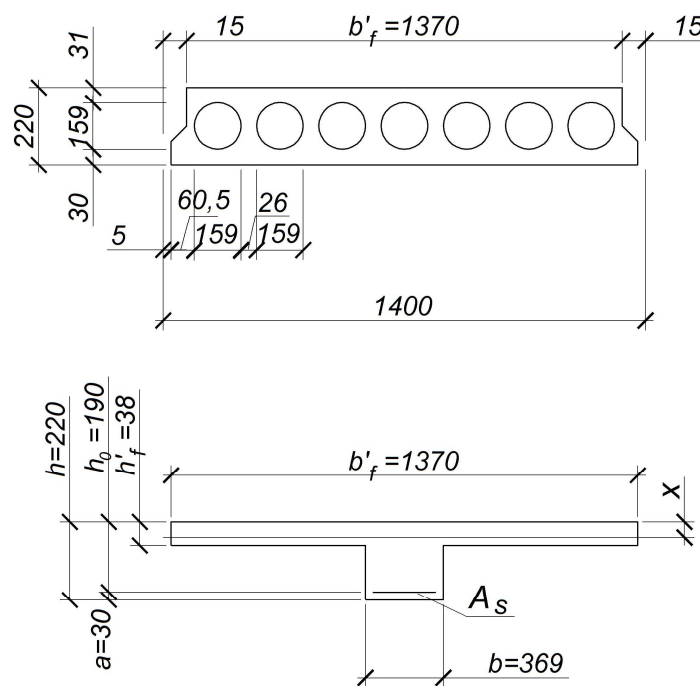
Поперечний переріз плити з круглими порожнинами
